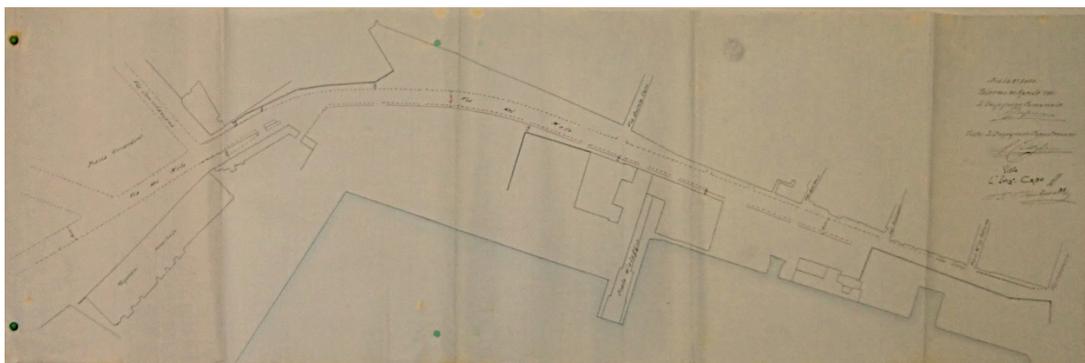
Planimetria del "Progetto per lo largamento del tronco di Via Molo compreso tra le vie Consolazione ed Arsenalè". Fonte ASCPa, Fondo LL.PP., serie 1141, 1901
